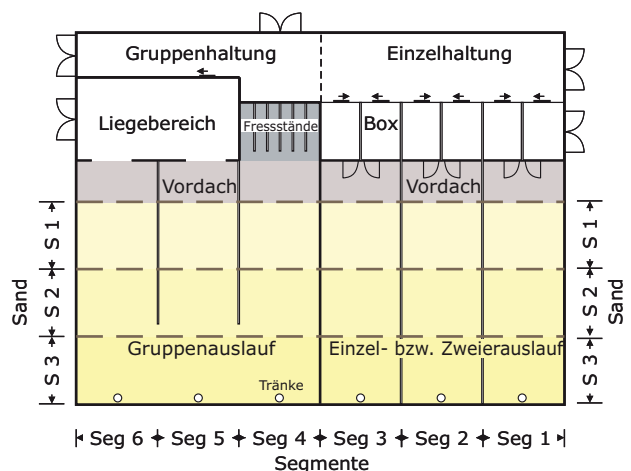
Grundriss der Versuchsanlage mit Einteilung der Beobachtungszonen zur Videoauswertung - Floor plan of the research facility with the classification of observation areas for video evaluation
